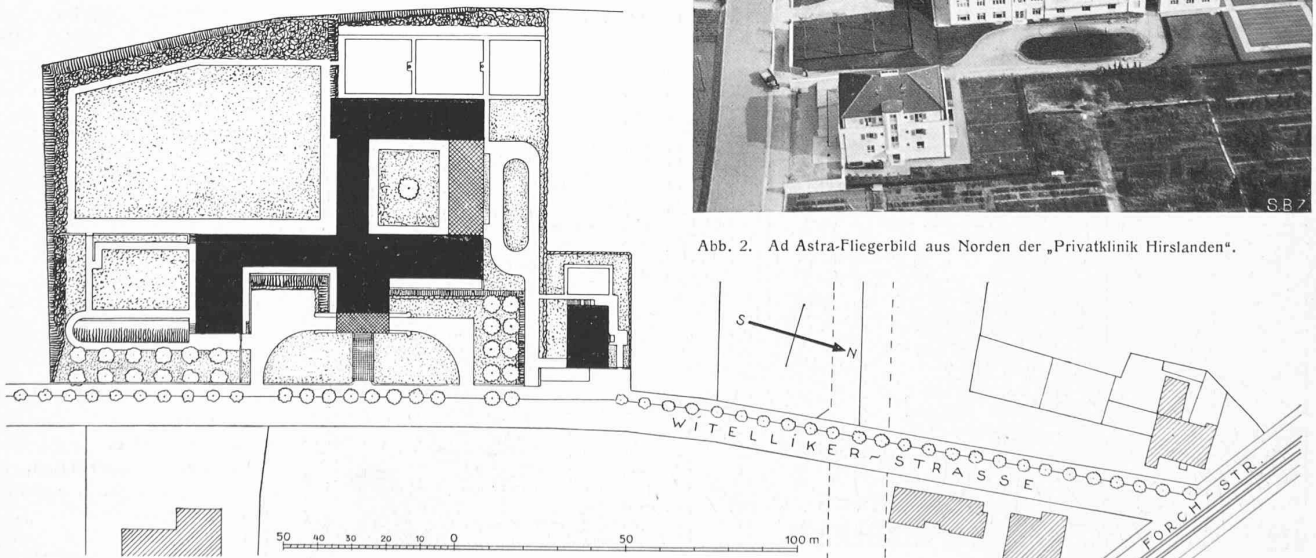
Lageplan. Rechts vorn das Dienstgebäude mit Heizung, Wäscherei, Näherei, zwei Beamtenwohnungen und 12 Einzelzimmern. — Masstab 1:2000.
